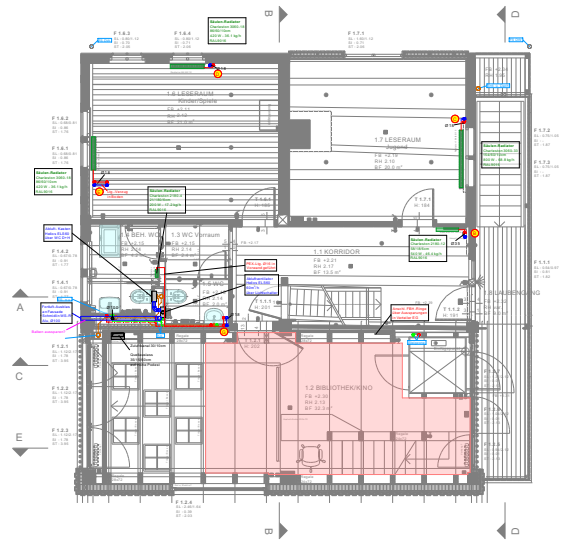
Grundriss 1. OG Koordinationspläne
